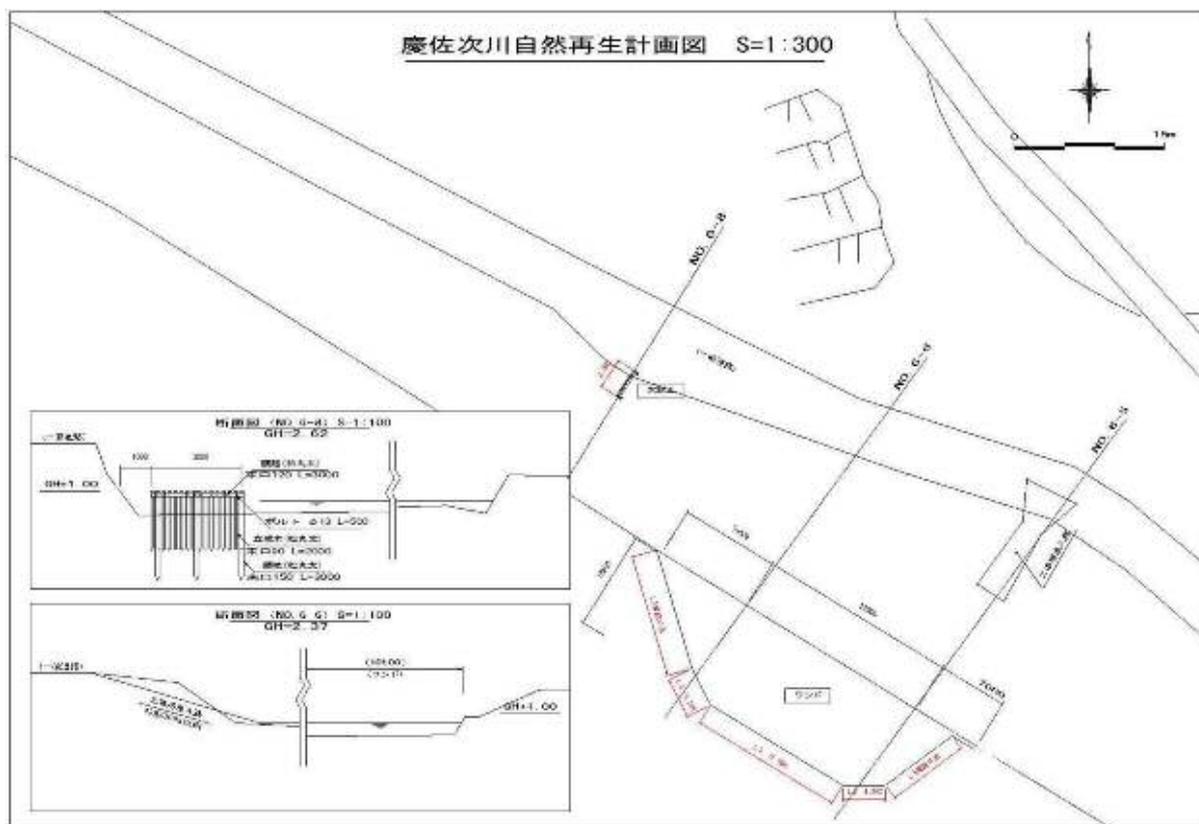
平成28年度 ワンド整備 計画平面図
